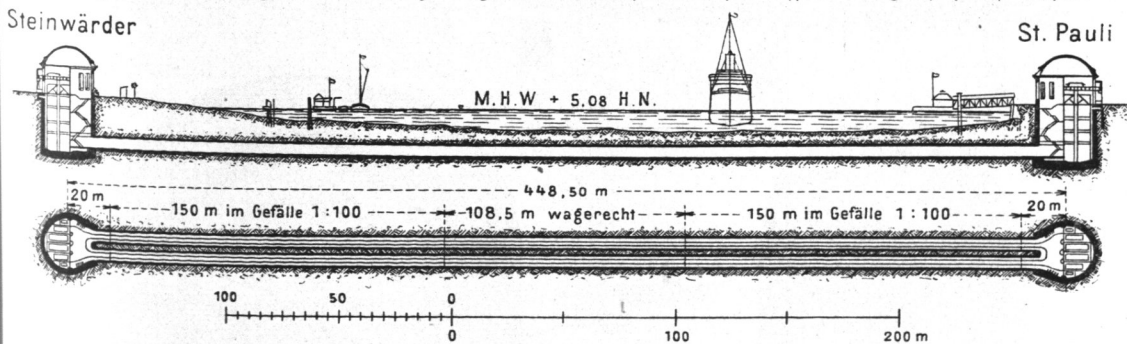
und 237. Längsdurchschnitt und Tunnelgrundriß.
